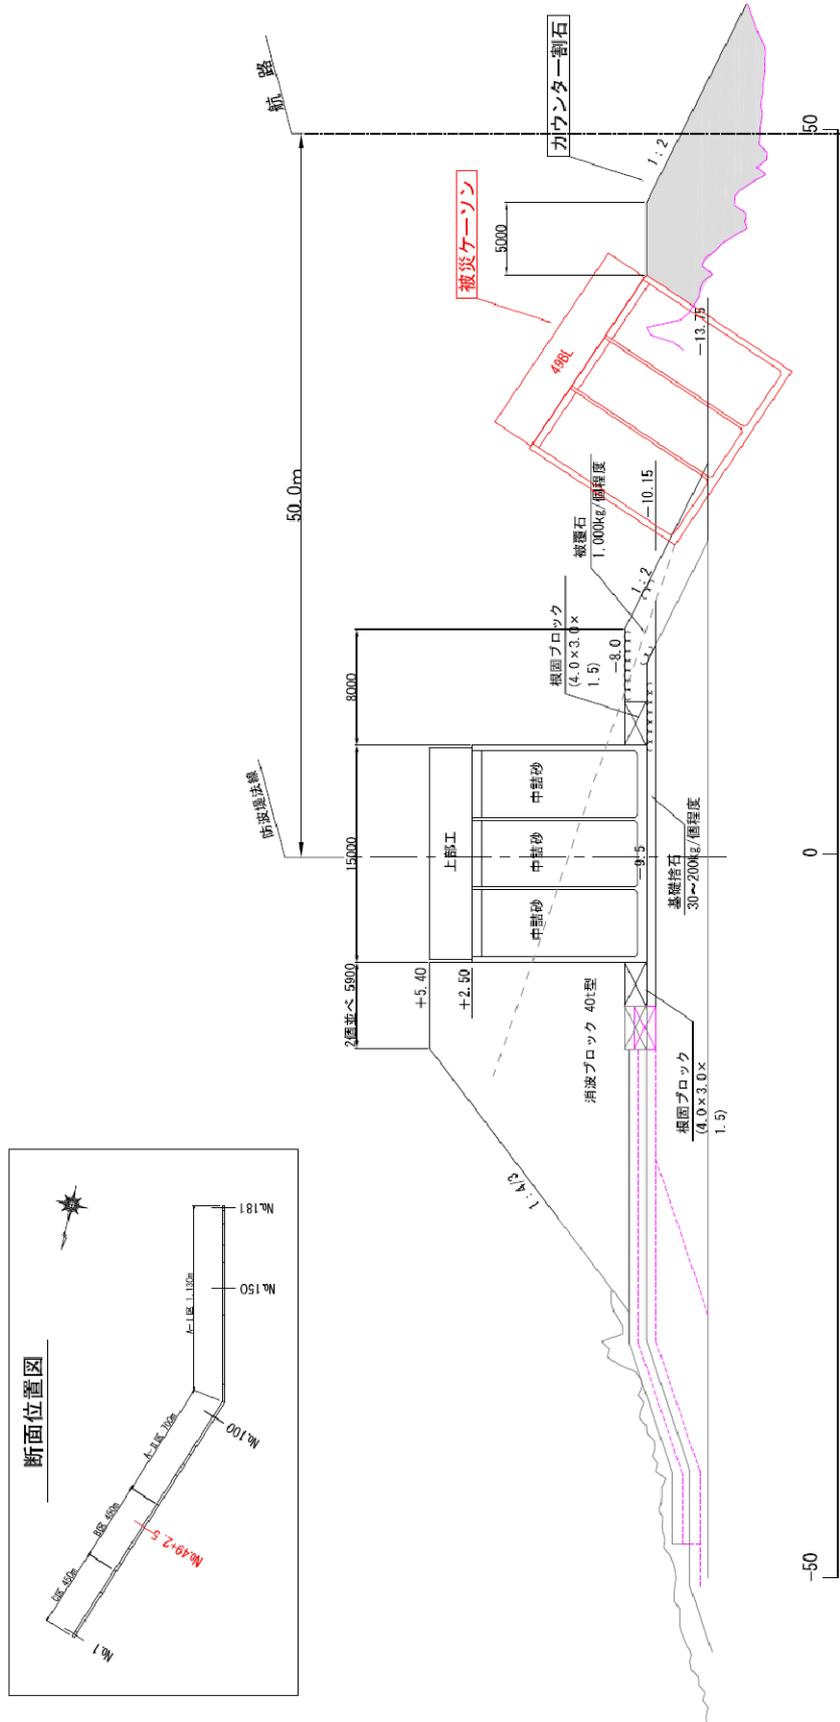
No.1 沖防波堤の断面図 B-1 区 (復旧後)
